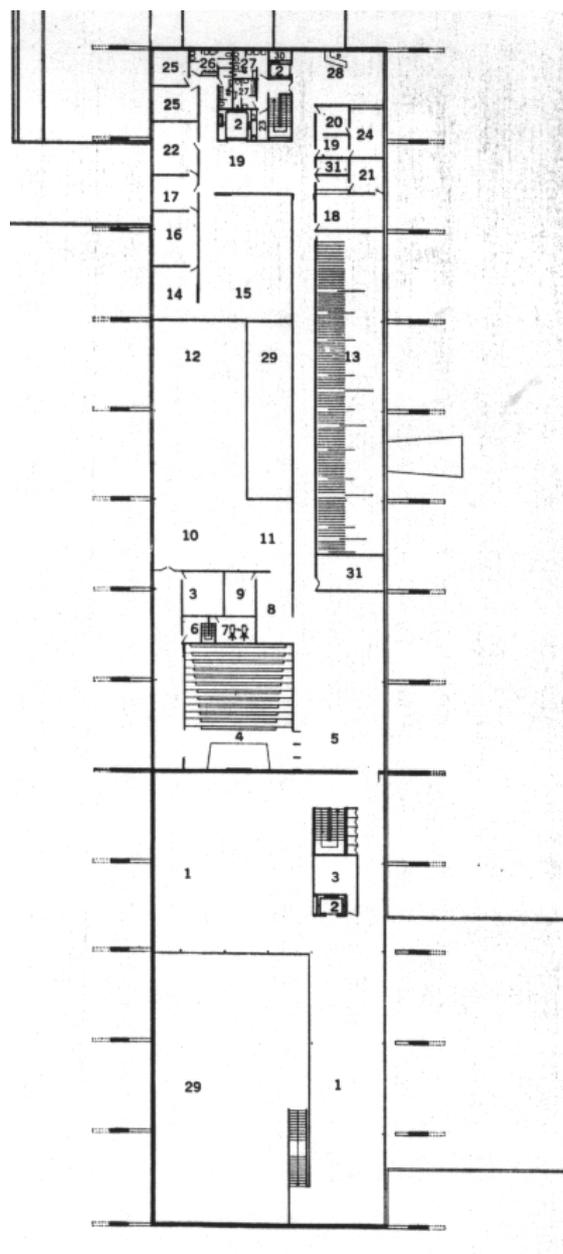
Plantas Baixa do Terceiro Pavimento
